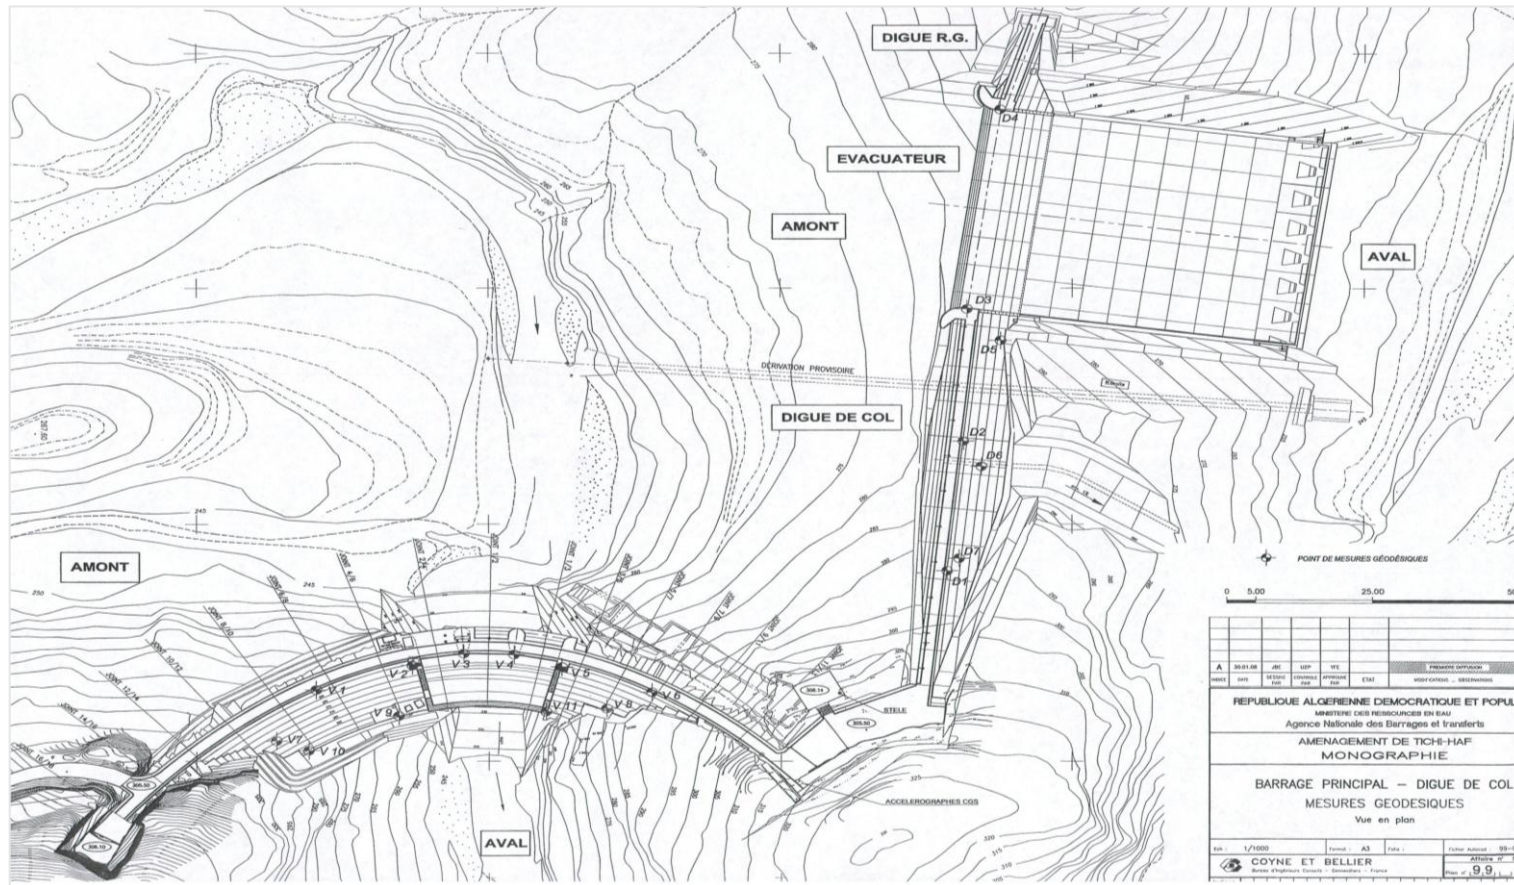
Vue en plan du barrage Tichy Haf, Ech : 1/2000 (source ANBT)
